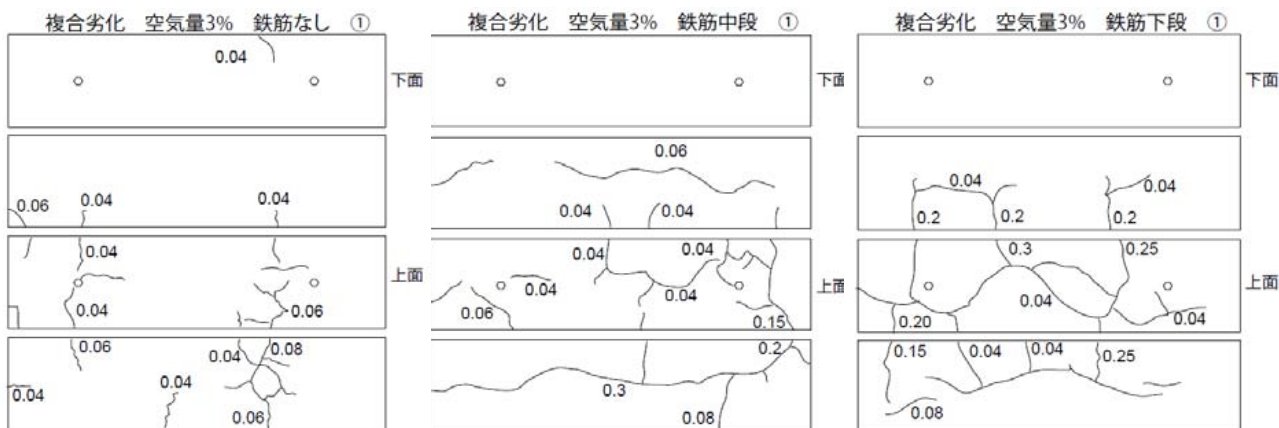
ASRによるひび割れ発生状況(図中の数字はひび割れ幅(mm))
